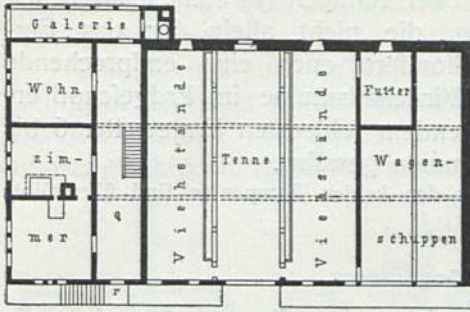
bis 503 sind die Grundrisse eines dreigescholligen Schwäbischen Bauernhauses.
